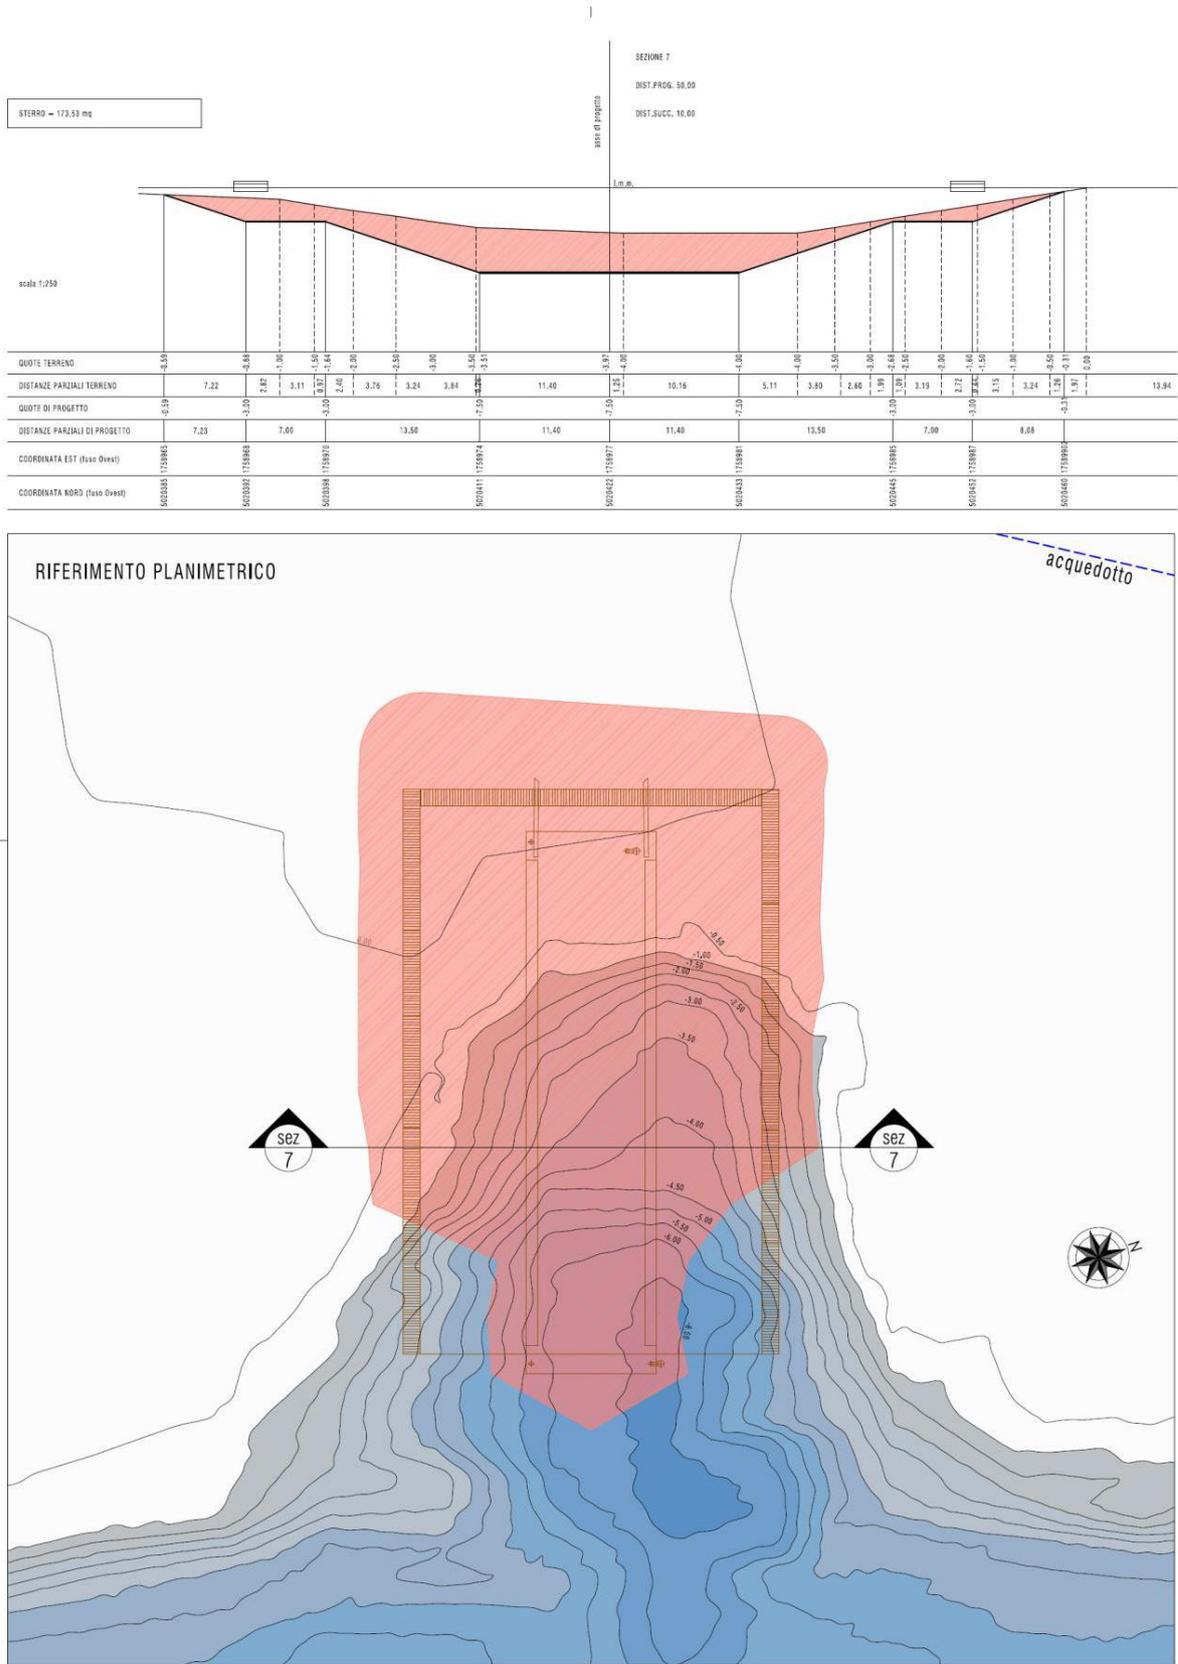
Estratto planimetria degli sterri e sezione trasversale di scavo dell'intervento "Adeguamento degli spazi acquei esistenti degli ex Cantieri De Poli"
